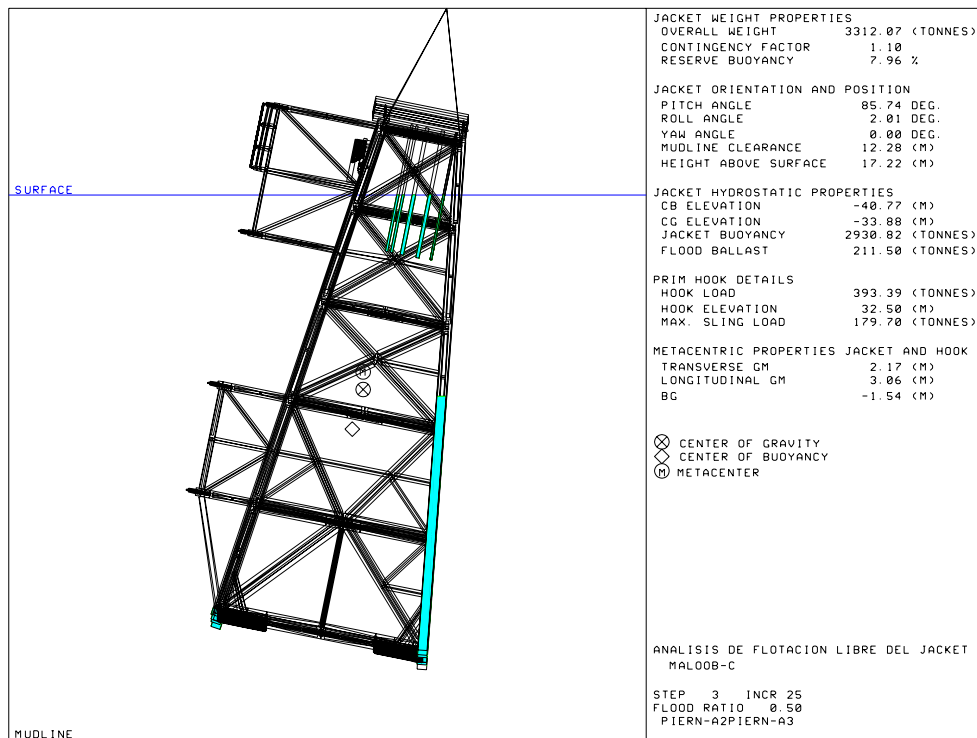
Posición de la estructura para una elevación de 32.50 m.
